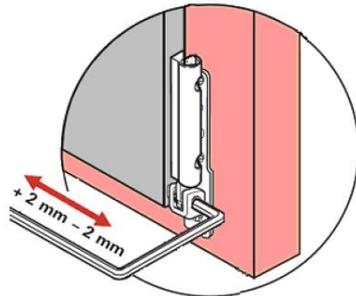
Horizontale Verstellung des Fensters (untere Türangel)
